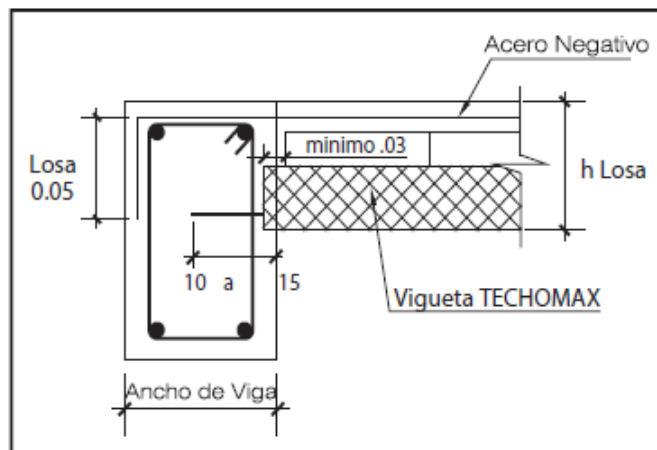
Detalle del anclaje de la vigueta prefabricada tipo Firth en apoyo continuo.
